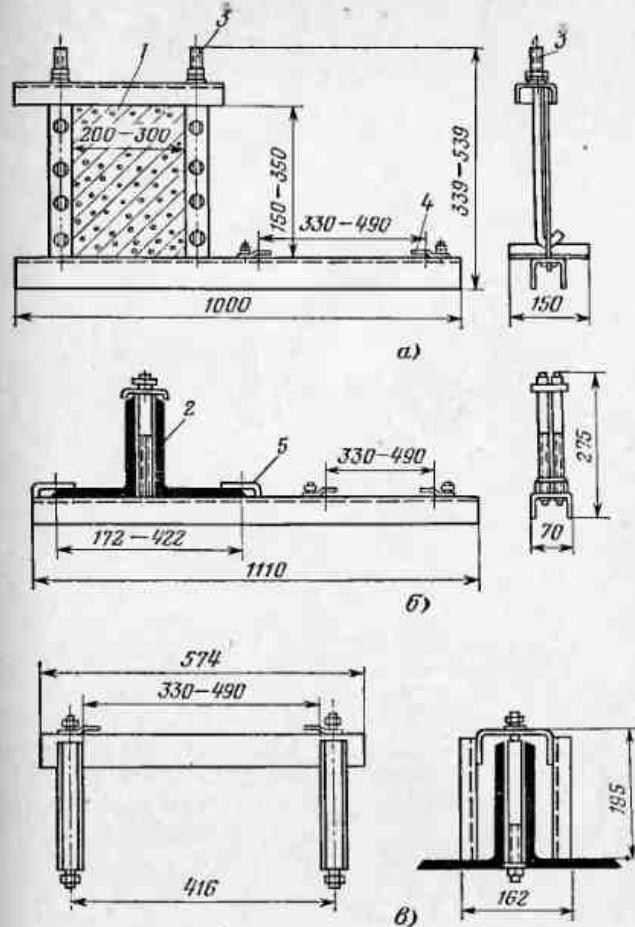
Опорные конструкции для установки магистральных шинопроводов на фермах зданий.
